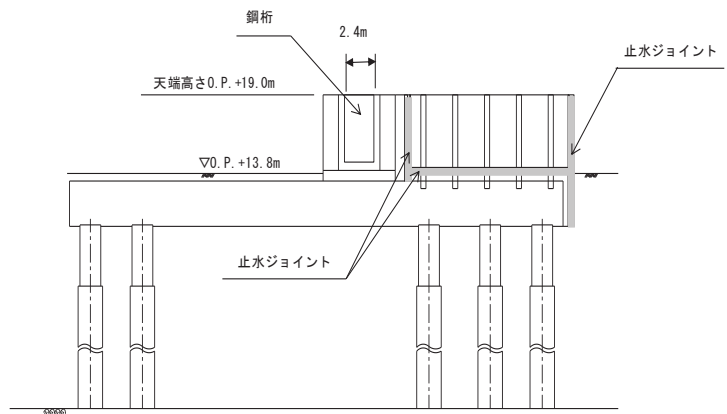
鋼製遮水壁（鋼桁）の平面配置図
